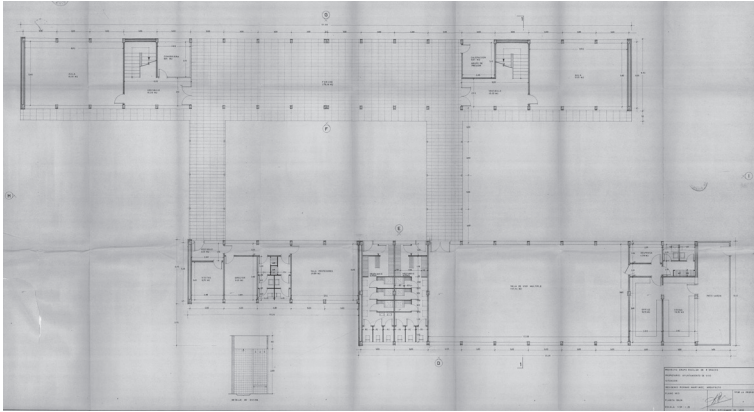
Grupo escolar, Ayuntamiento de Vigo, 1968. Planta baja. Archivo Histórico Municipal de Vigo. Arquitectura escolar, caja 44.
